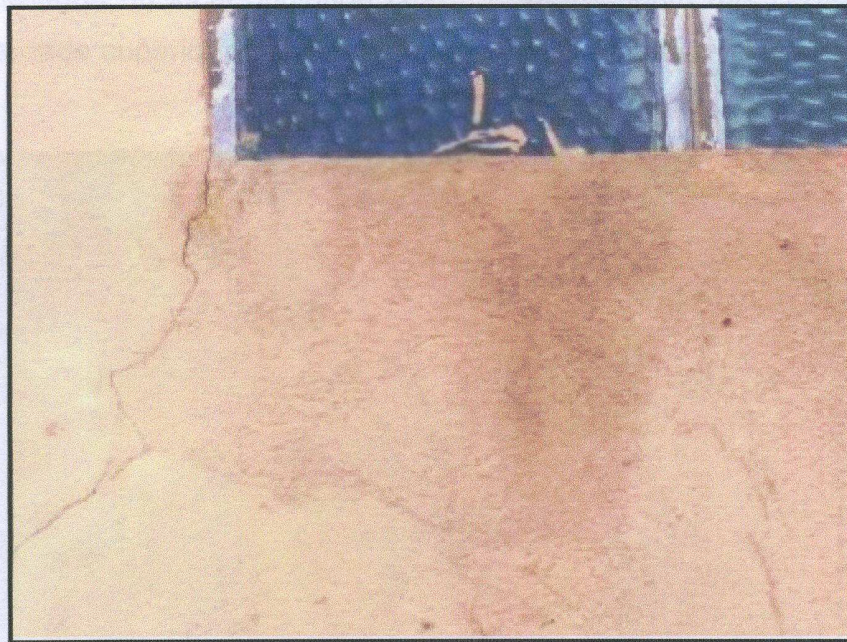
72 – fissuras verticais na alvenaria.
